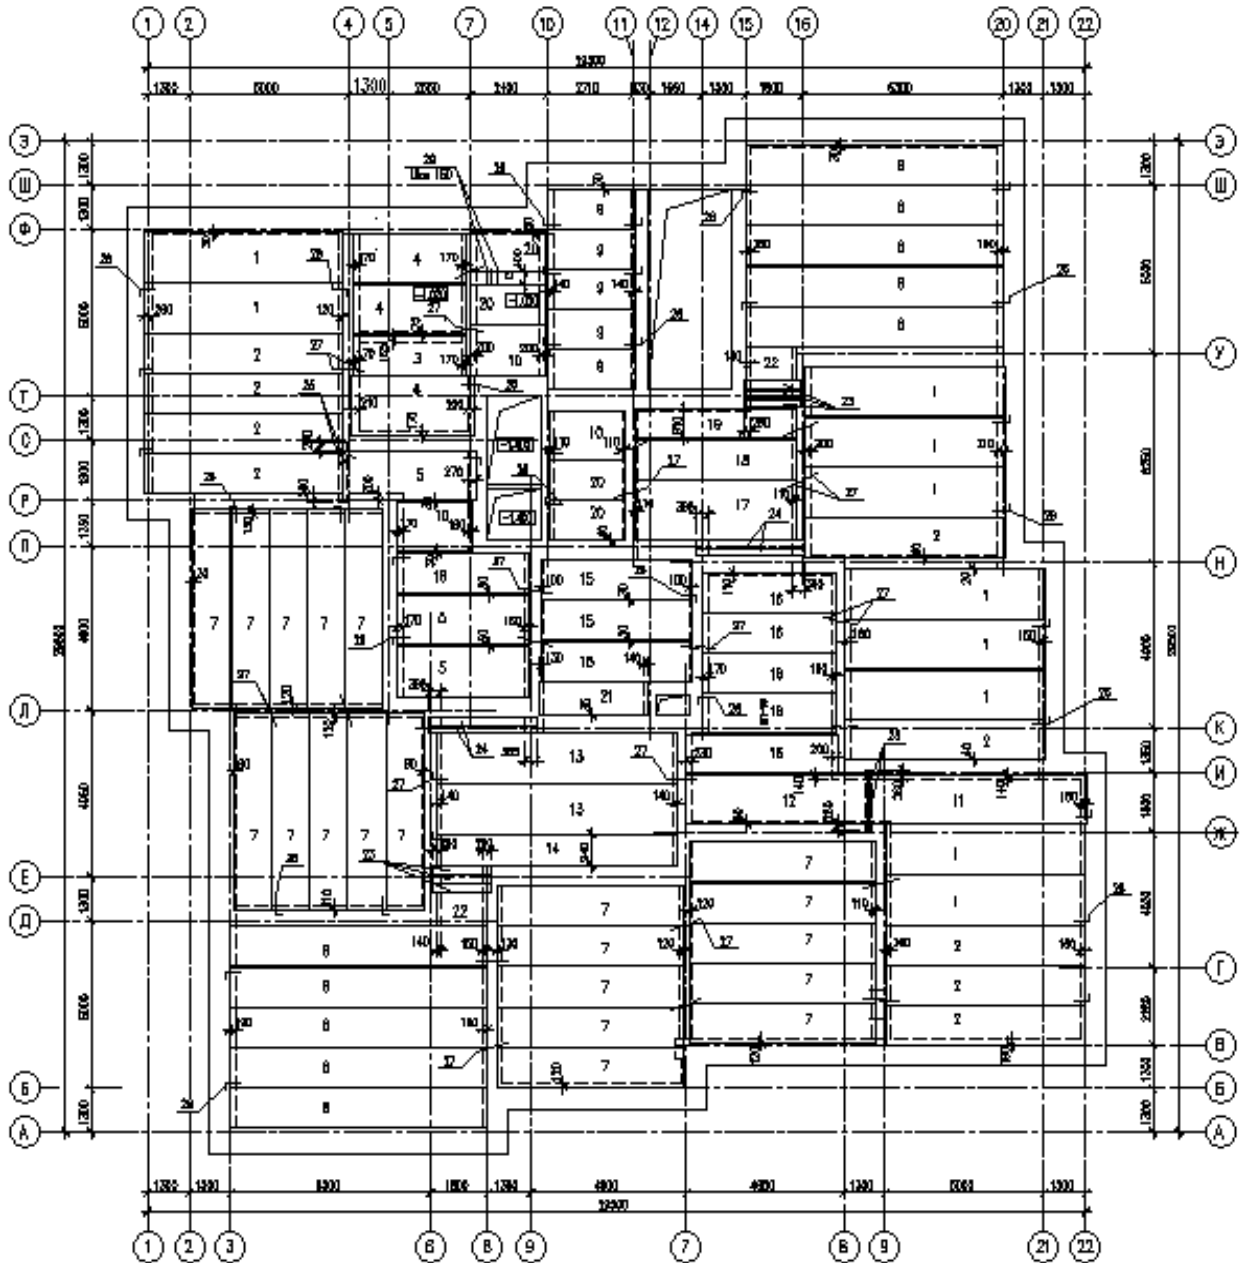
Схема расположения плит перекрытия на отм. 0,000
